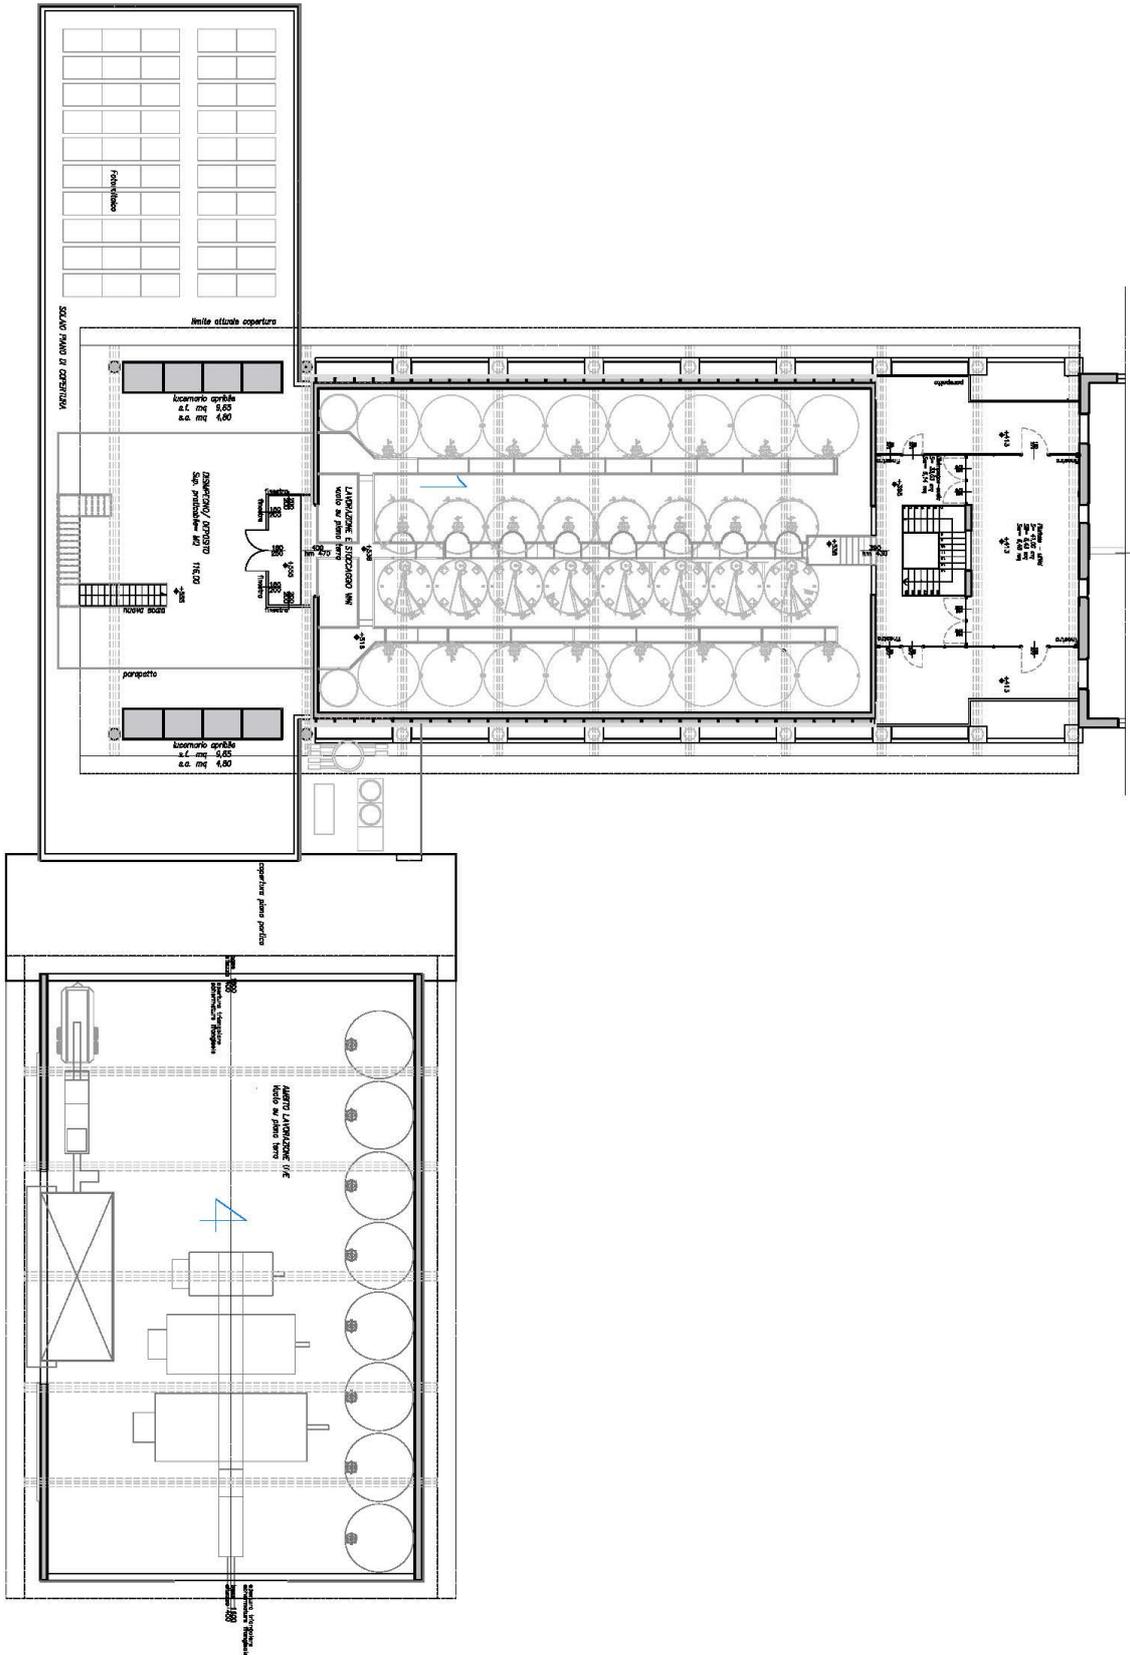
Planimetria piano primo con determinazione dei parametri di illuminazione ed areazione.
